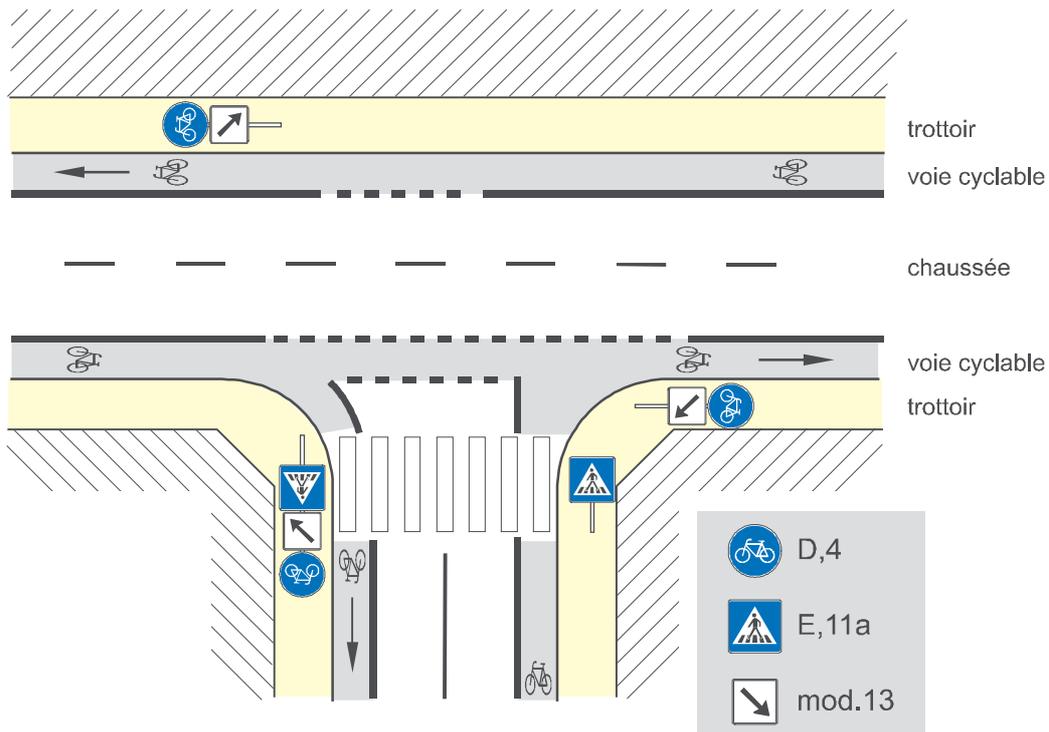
jonction en T d'une chaussée comportant une voie cyclable avec une autre chaussée (priorité à droite)
